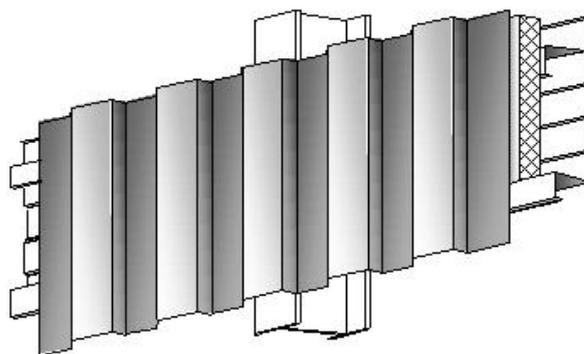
Aufbau zweischaliger, wärmedämmter Wände
